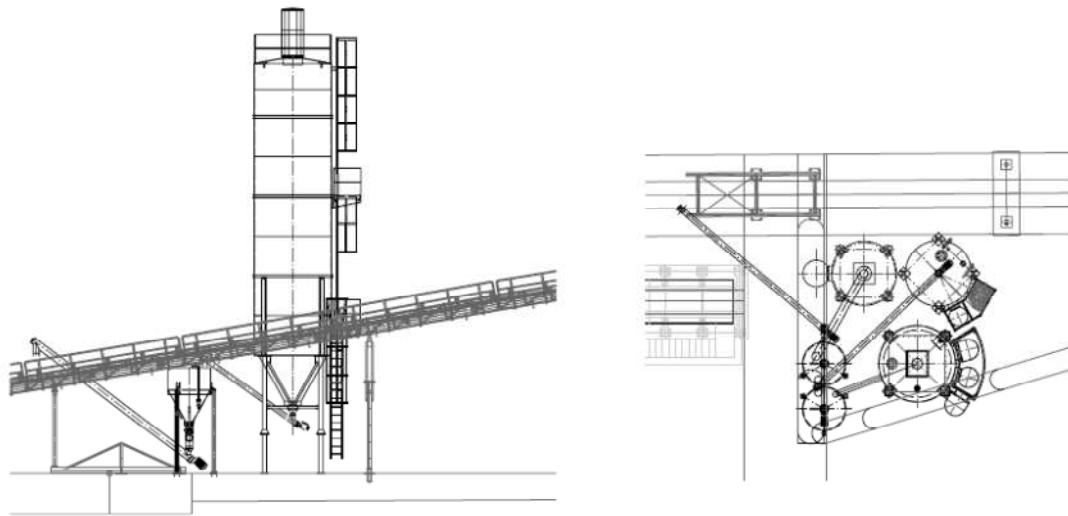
Croquis en planta y perfil de la planta de dosificación de Cal.
